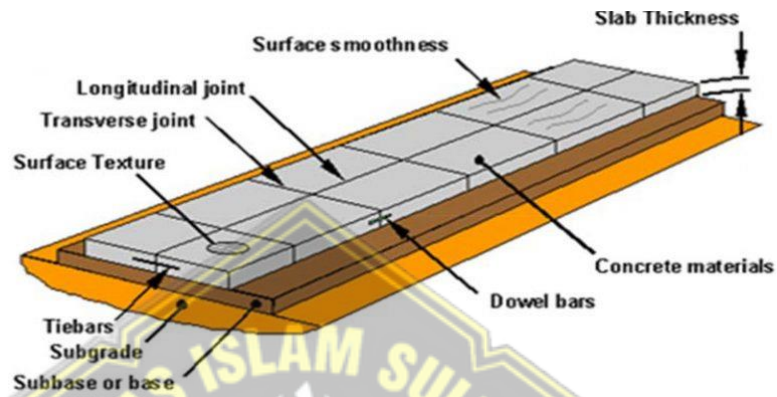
Skema Perkerasan Beton Semen Menerus dengan Tulangan
